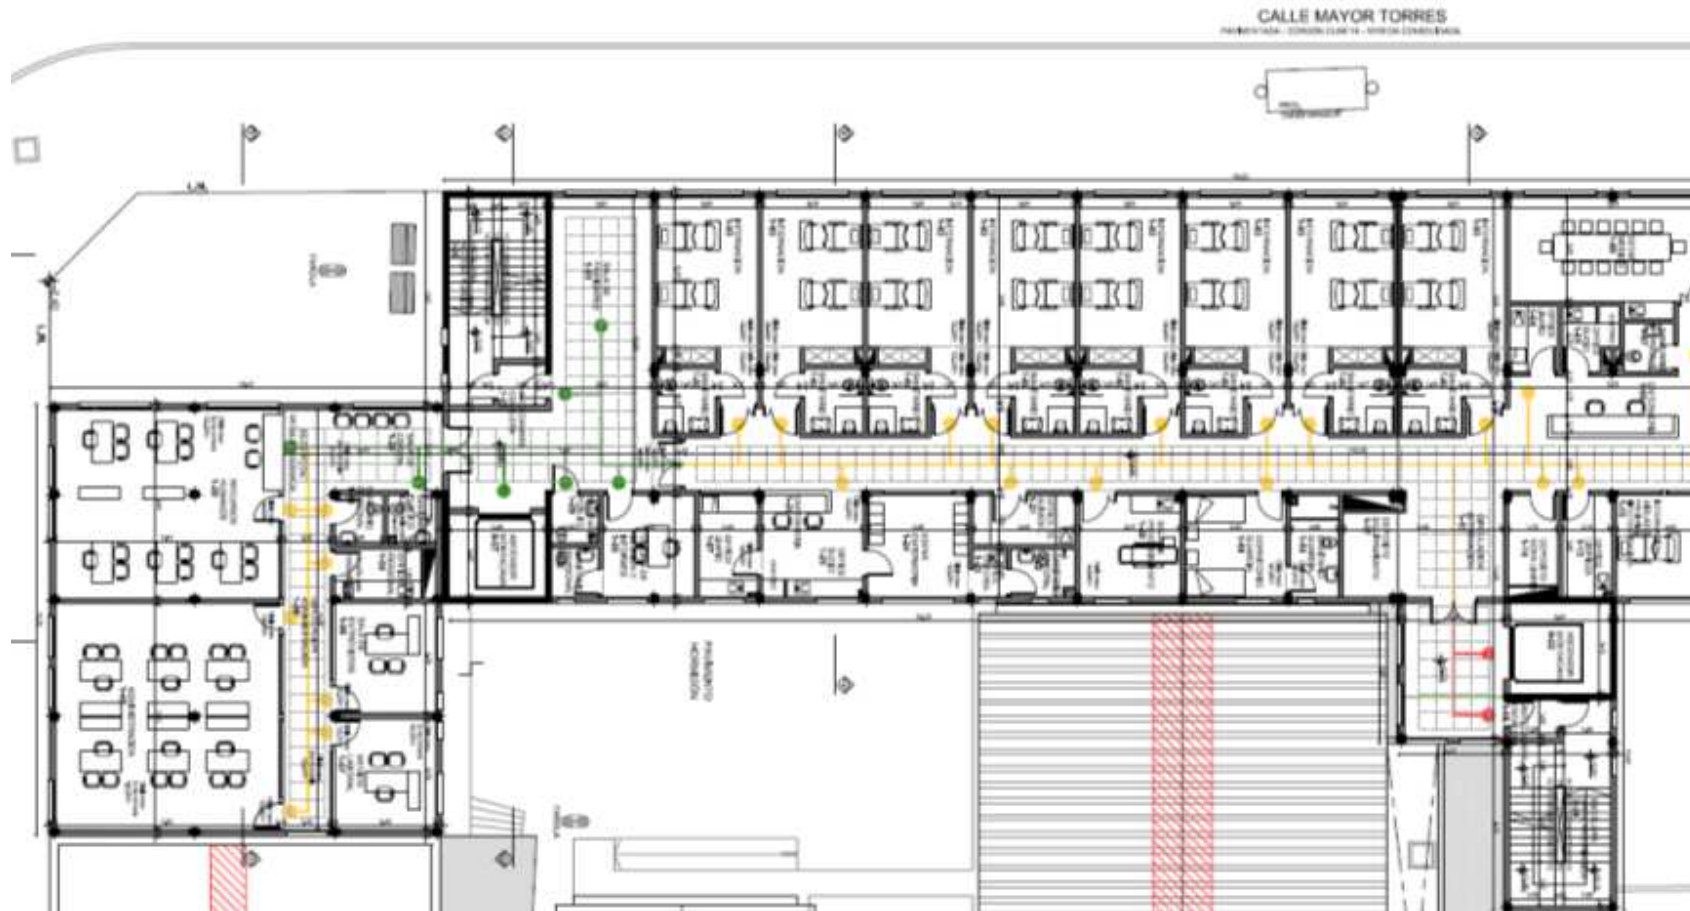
Primer piso a construir con la ubicación de los sectores de internación y enfermería.
